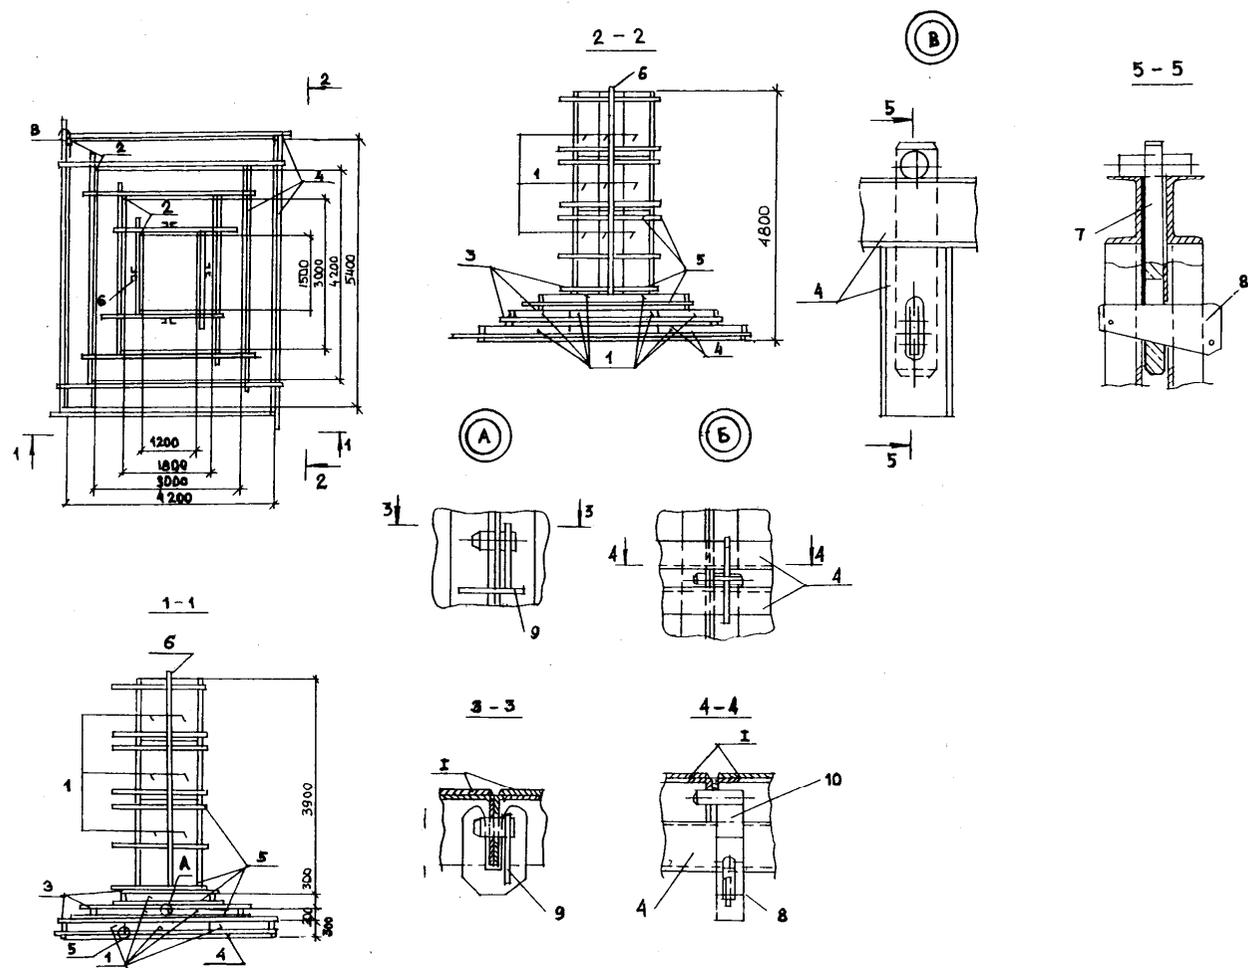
Схема конструкции опалубки фундамента под колонну:
